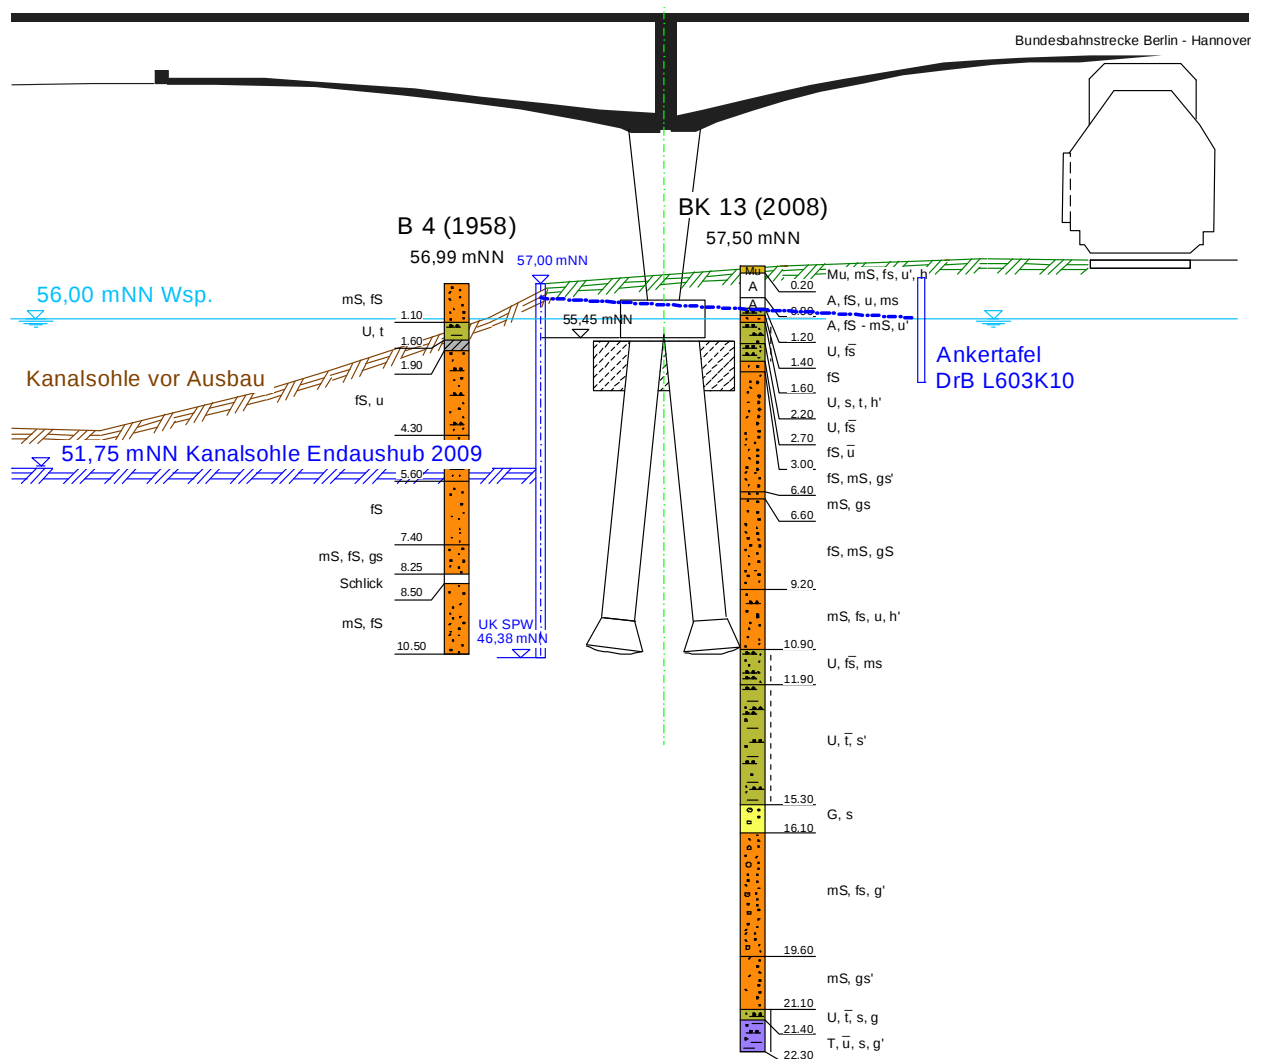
Pfeilergründung, Ufereinfassung und Baugrundaufbau
